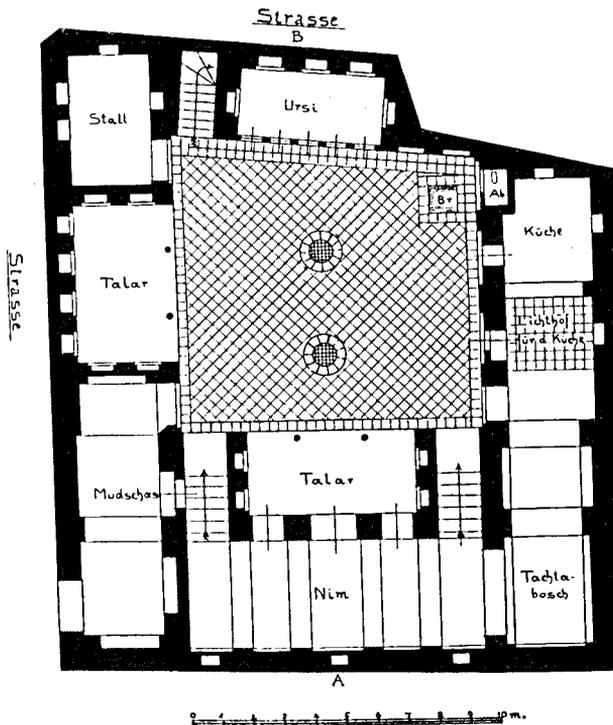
Haus Schaschür, Bagdad. Erdgeschoß.
